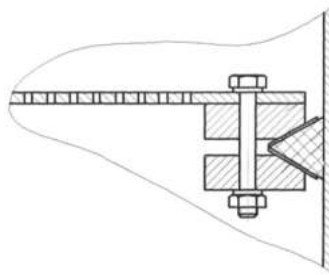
Схема опорного пристрою згідно з пат. № UA113944U
